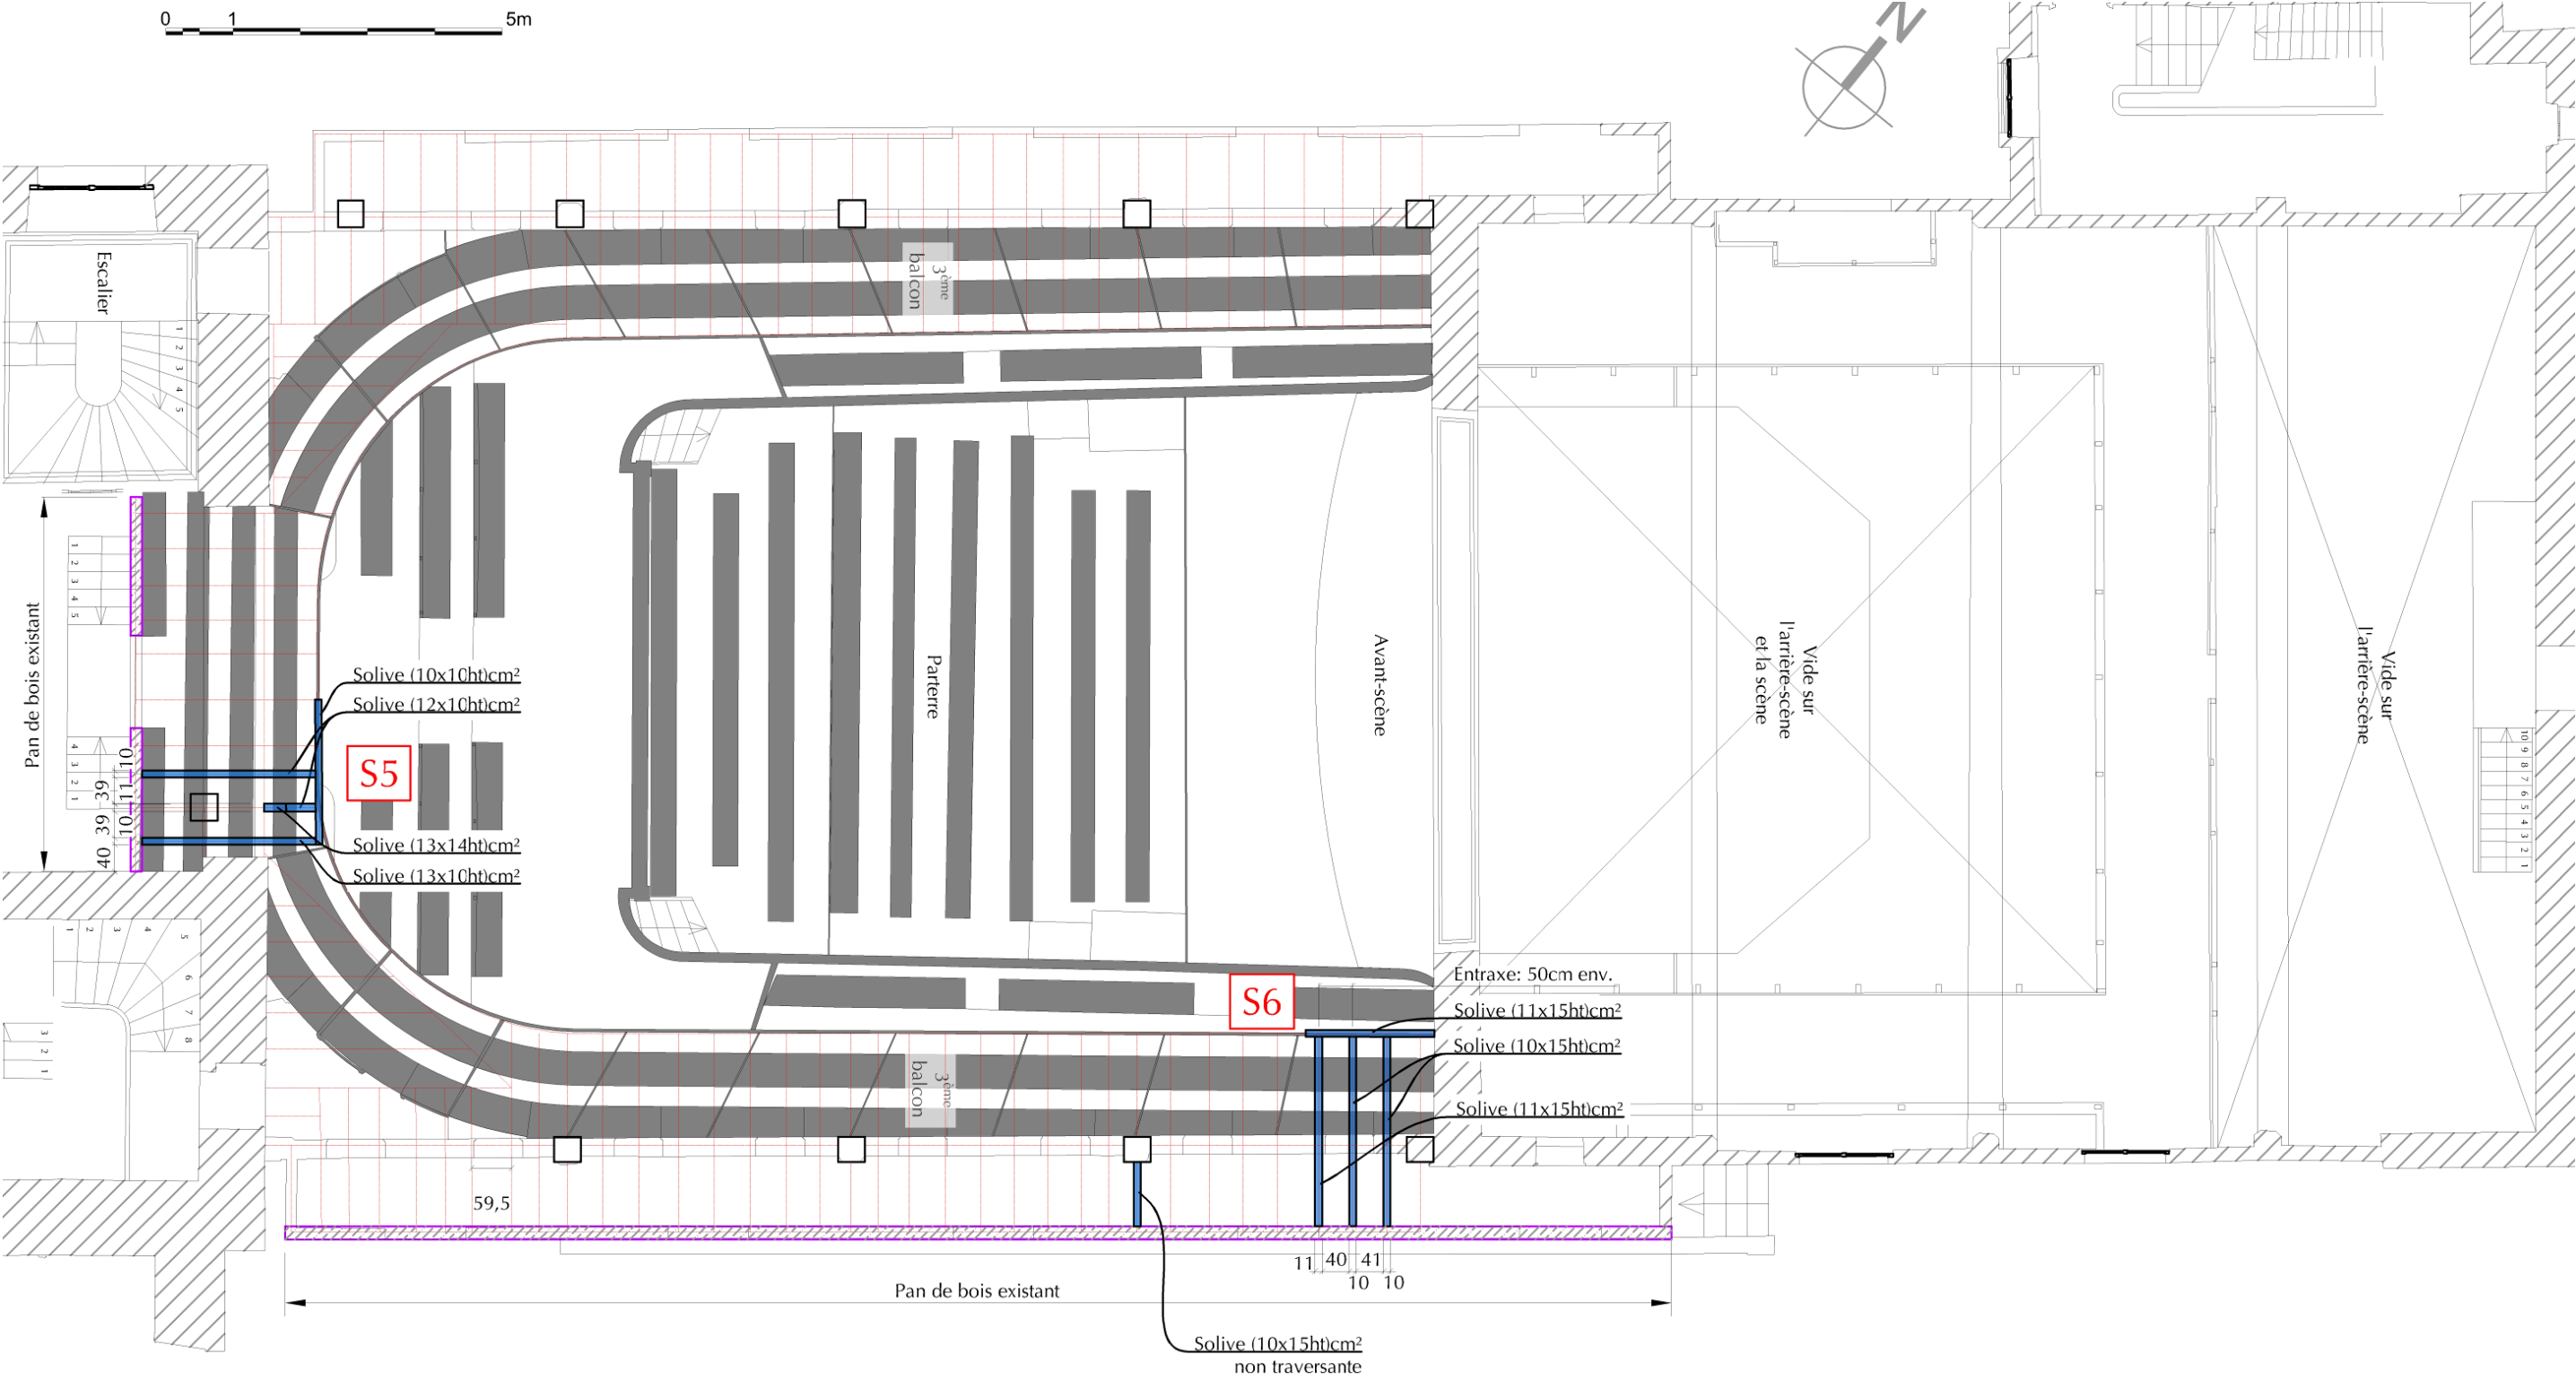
Vue plan du 3^{ème} balcon – Plan de localisation sondage – NOTA : les traits pointillés rouge représente la structure issue des plans d'archive
